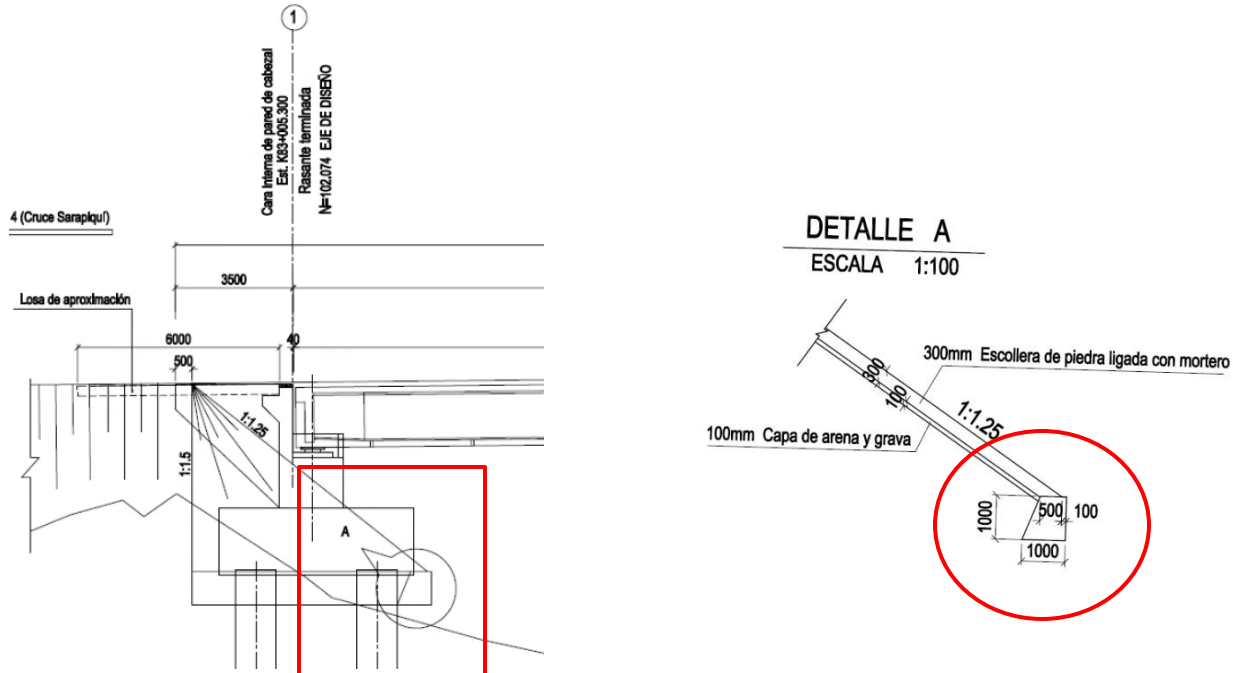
Detalle de las escolleras ligadas con mortero del puente nuevo sobre el río Dos Novillos.
